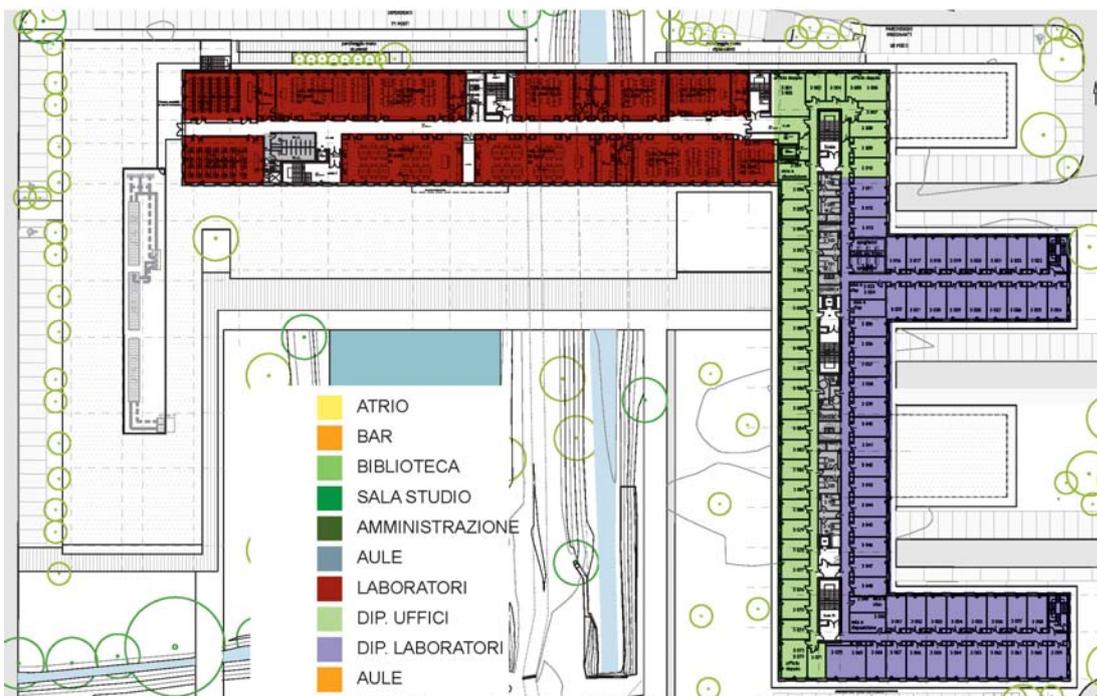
Pianta piano terzo Lotto 1-2 e identificazione funzionale
